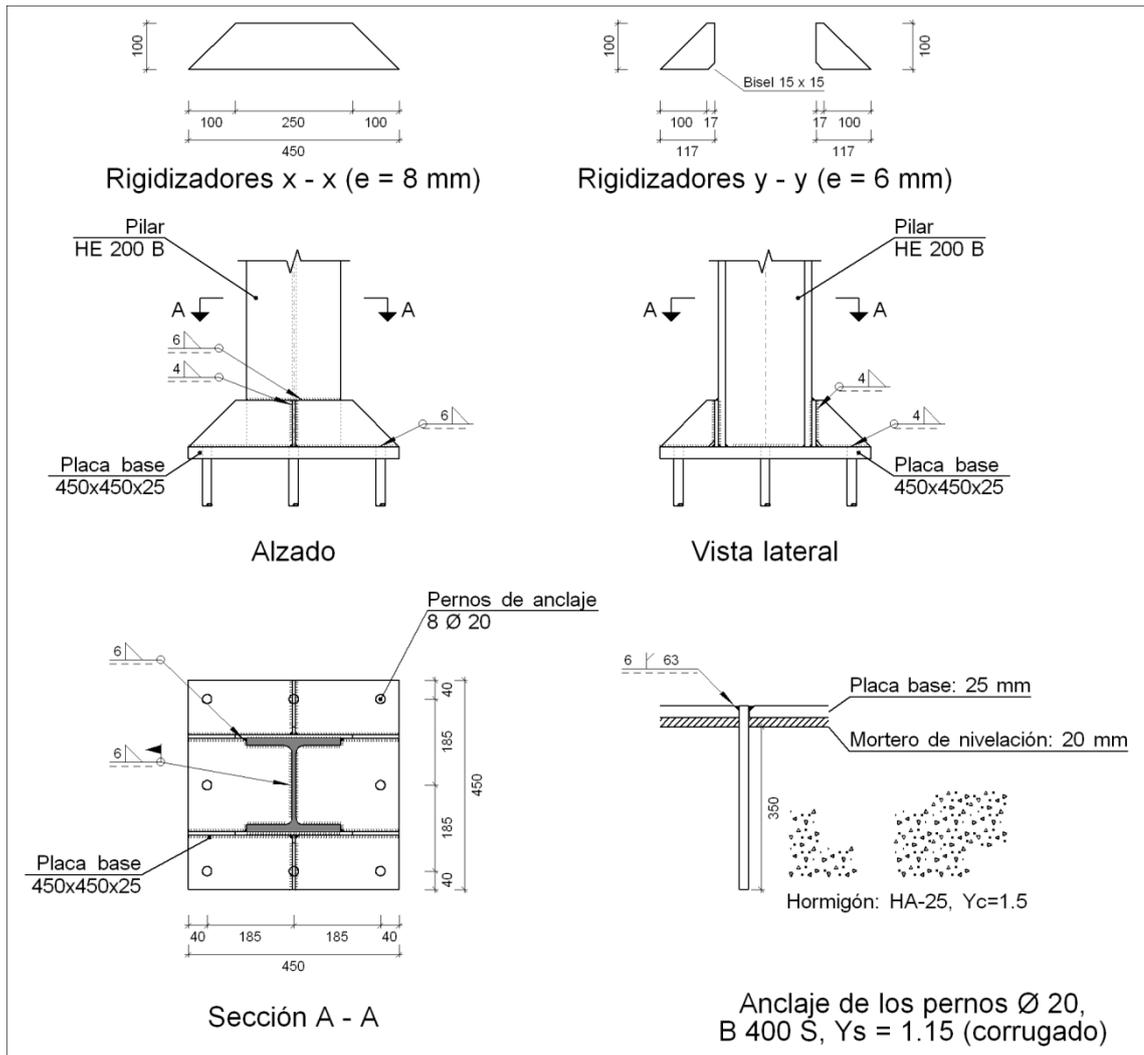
Vistas en planta y perfil de las placas de anclaje.
